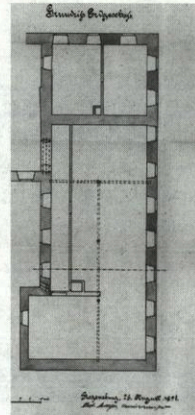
Obermünsterplatz 7, Grundriss des Nordflügels 1893 (BOAR).
